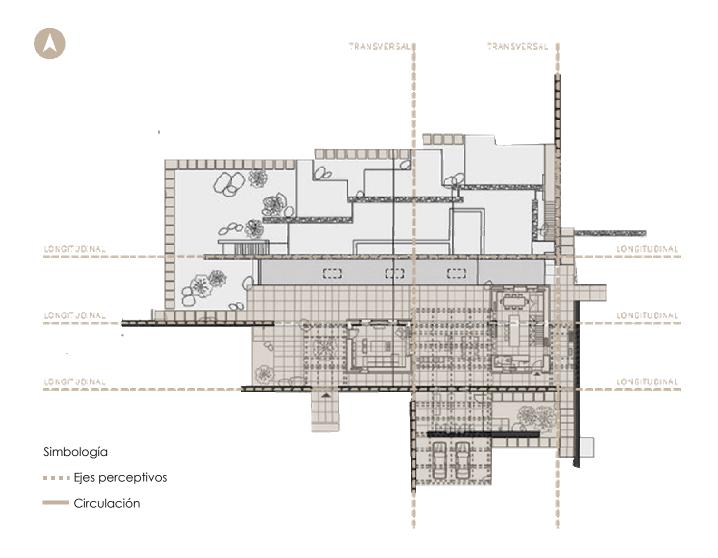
Planta arquitectónica con ejes y circulaciones de "Villa Mandra" proyecto de K-Studio.
